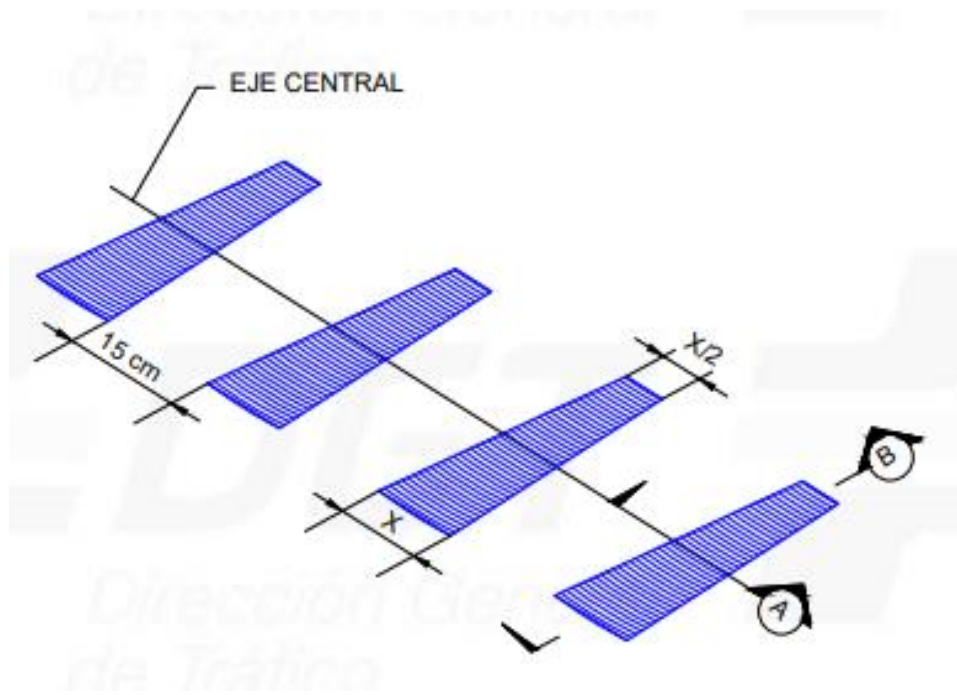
DGT (2018). Vista isométrica de guía sonora longitudinal de tipo trapezoidal
